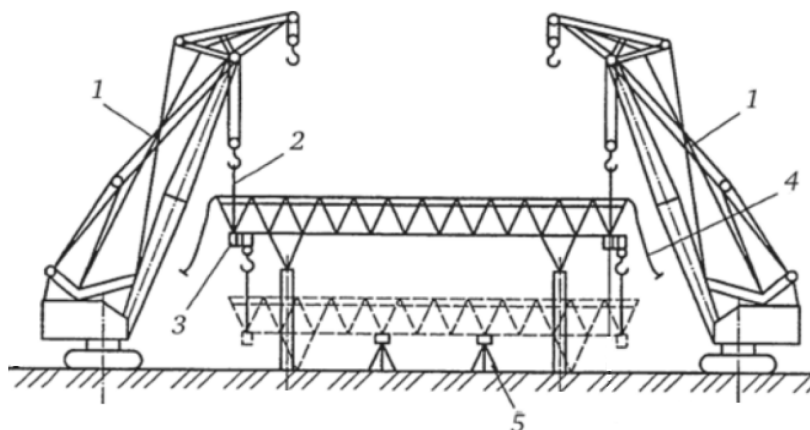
Схема монтажа несущей конструкции покрытия двумя самоходными кранами:
